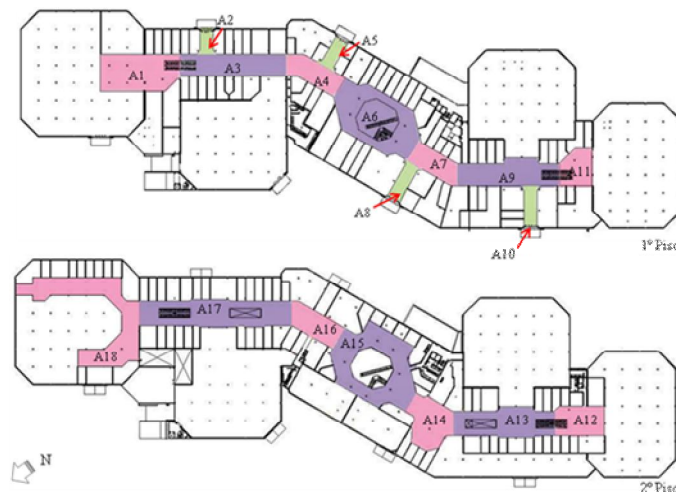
Planta baixa do Maceió Shopping dividida em dezoito áreas para levantamento *in loco*.
